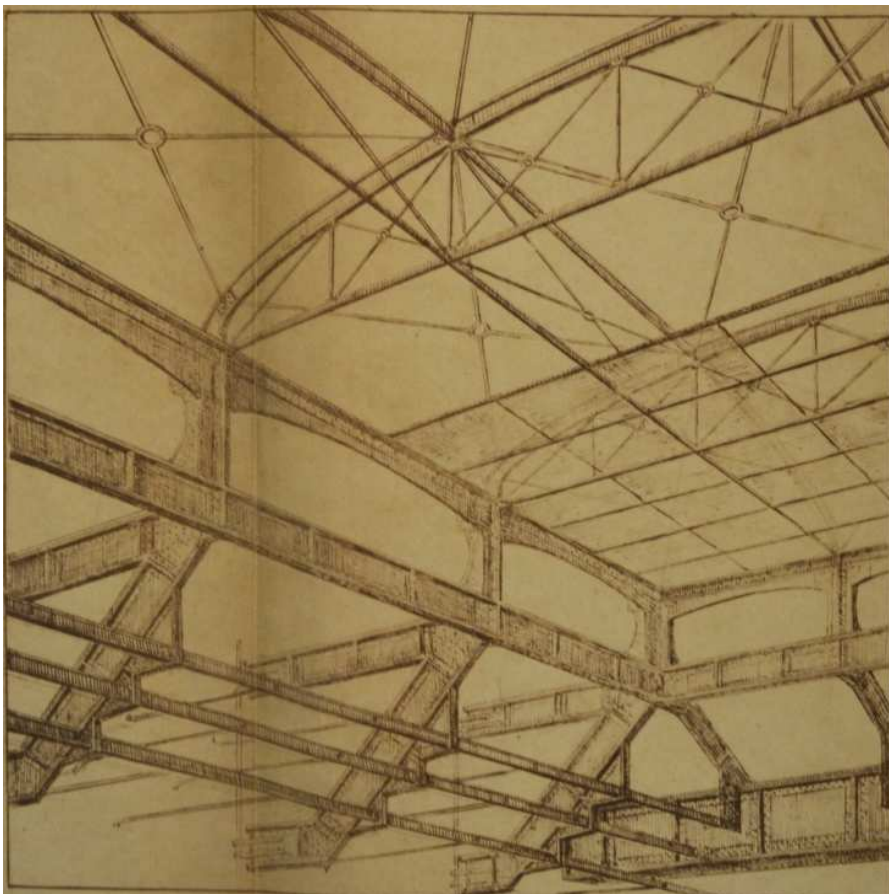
Schizzo prospettico dell'armatura in ferro sorreggente il soffitto e il lucernaio a cristalli di uno dei due scaloni del prospetto sul Lungotevere (1902) (ACS, Roma, Min. LL.PP., OGE, Palazzo di Giustizia, b. 212, fasc. 520)
